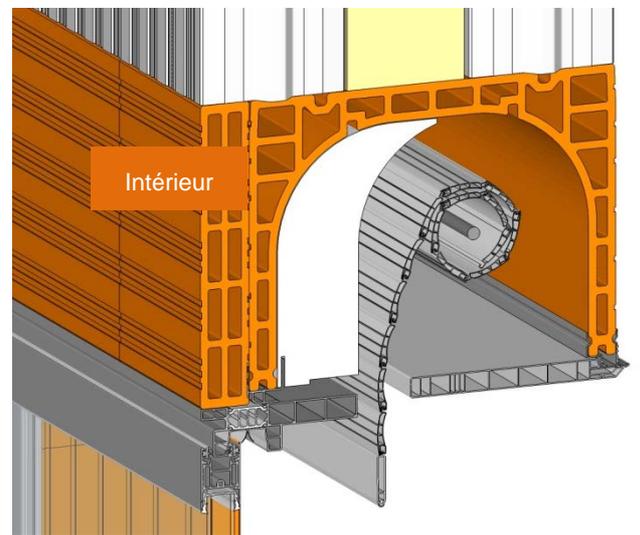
Coffre CVR Full brick 375 + planelle 50 mm
